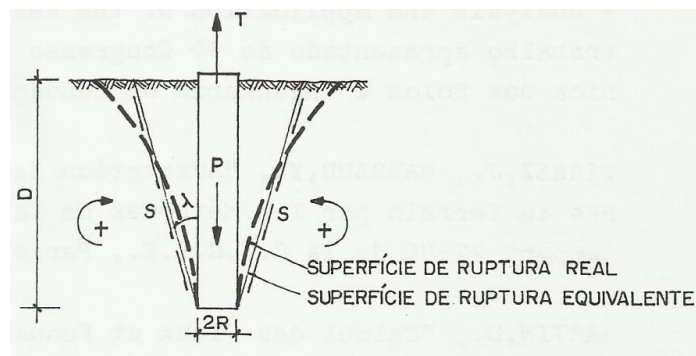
Superfície de Ruptura a Tração - Estaca Cilíndrica
